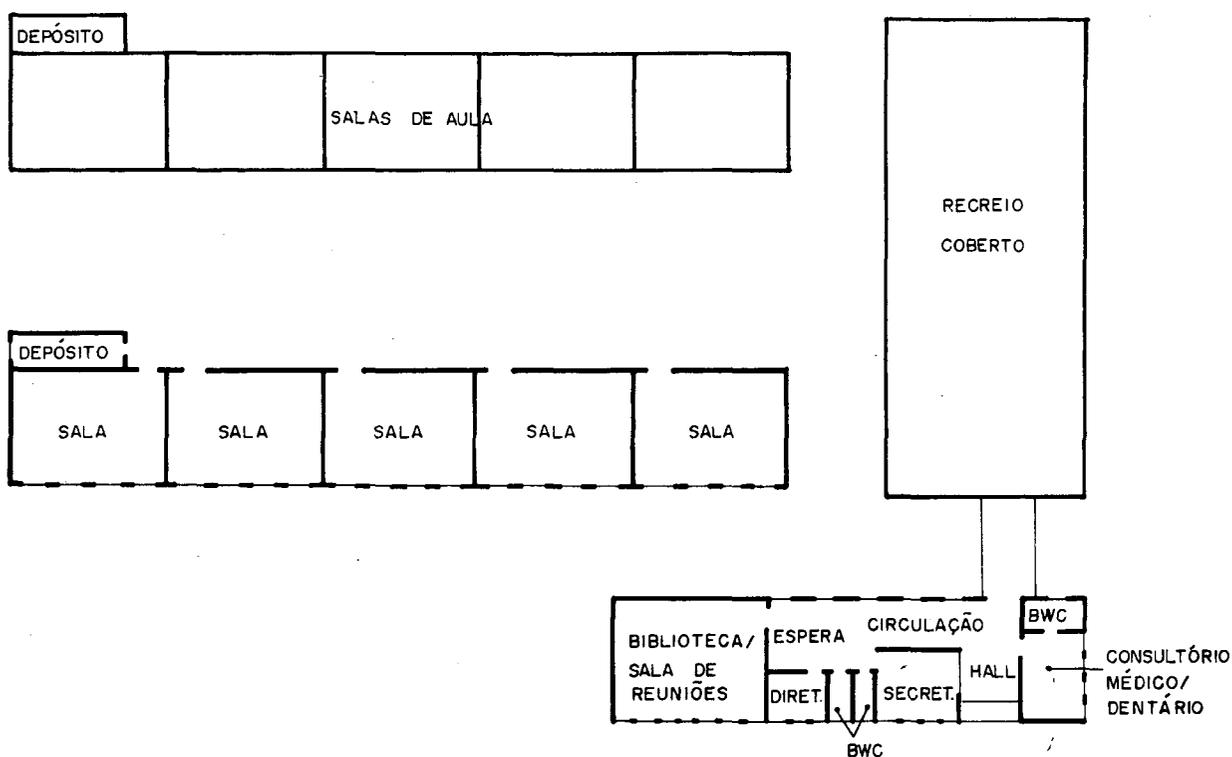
Planta baixa padrão das escolas construídas pelo PLAMEG.
